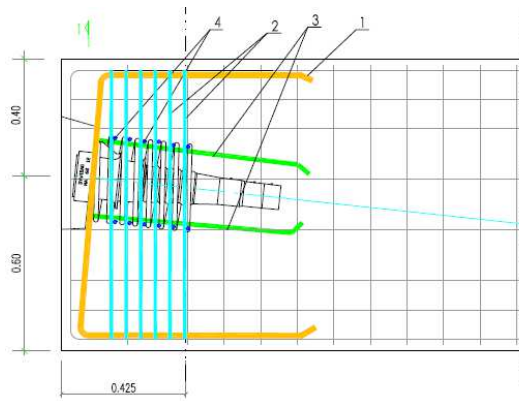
Corte lateral, armaduras de reforço . Pré-esforço).
